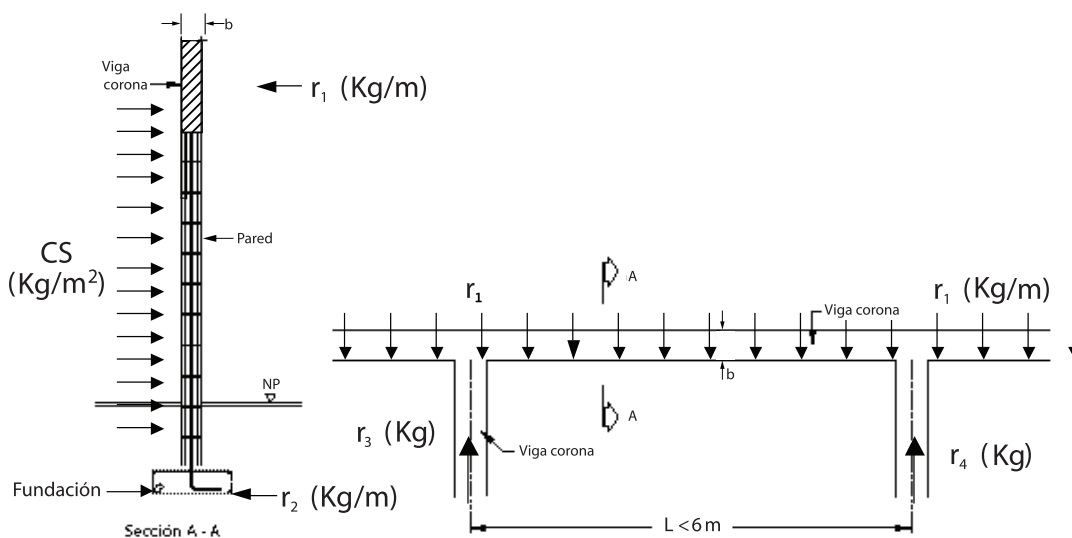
Detalle de viga corona para rigidizar paredes.
